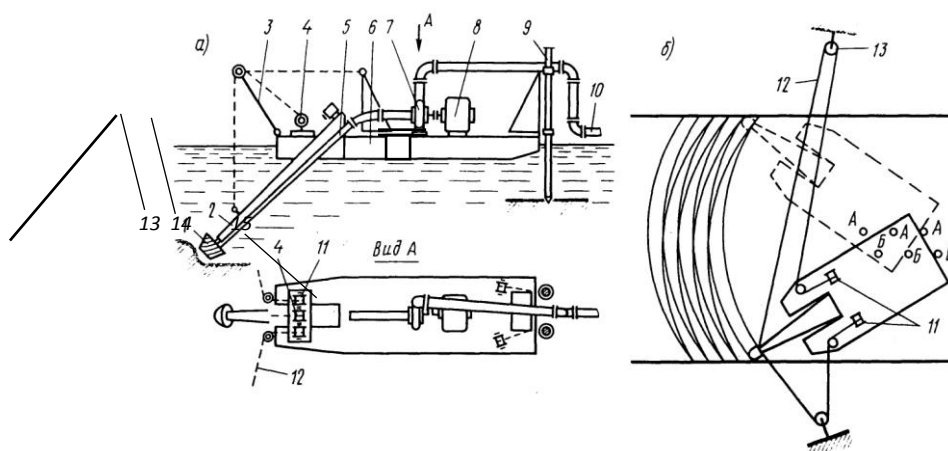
Схема земснаряда: *а* – вид сбоку и сверху; *б* – схема свайно-тросового папильонирования; 1 – рыхлящий орган; 2 – рама; 3 – стойка; 4, 11 – лебедки; 5 – всасывающий трубопровод; 6 – корпус; 7 – грунтовой насос; 8 – двигатель; 9 – сваи; 10 – пульпопровод; 12 – канаты; 13 – отводные блоки; 14 – гибкая вставка; 15 – лебедочный механизм
